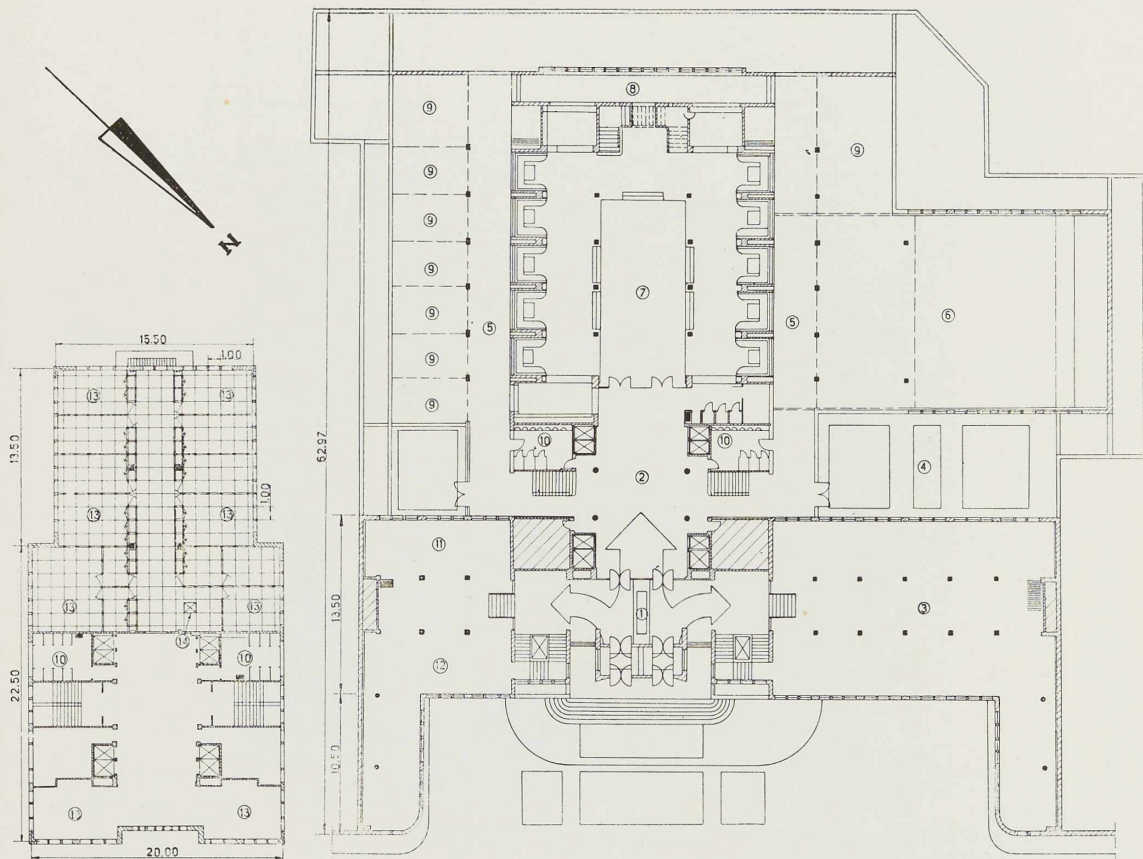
et 266. Plans d'un étage normal (à gauche) et du rez-de-chaussée (au-dessus).
